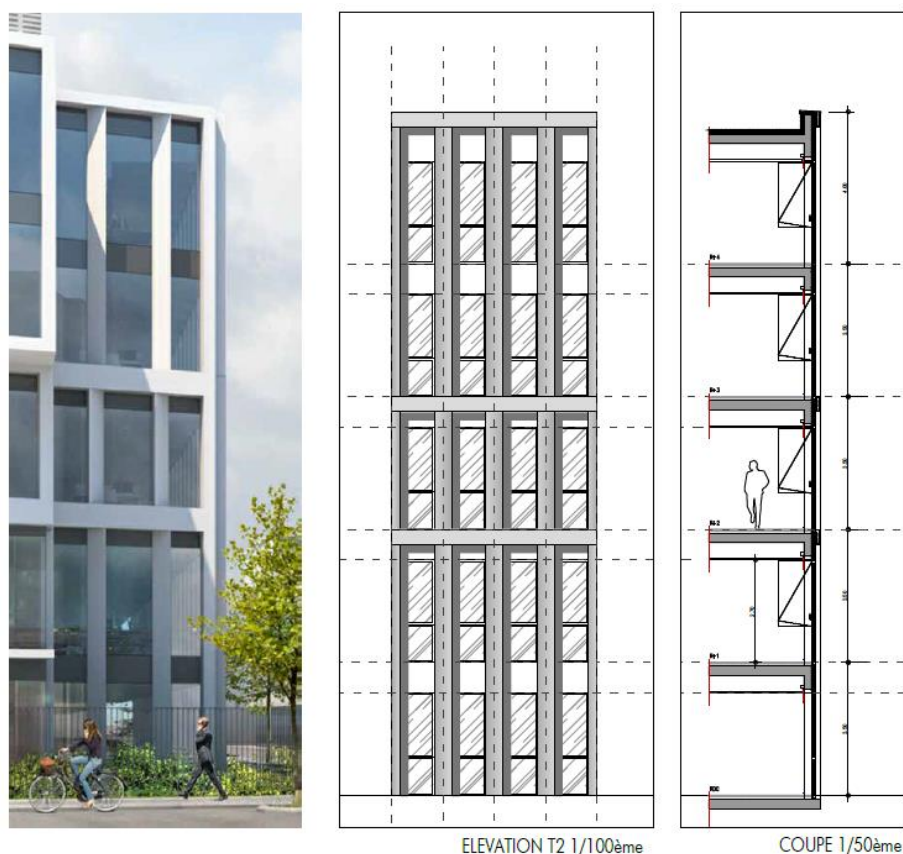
Visuel d'une façade accessible par l'extérieur (CALQ, avril 2020)
